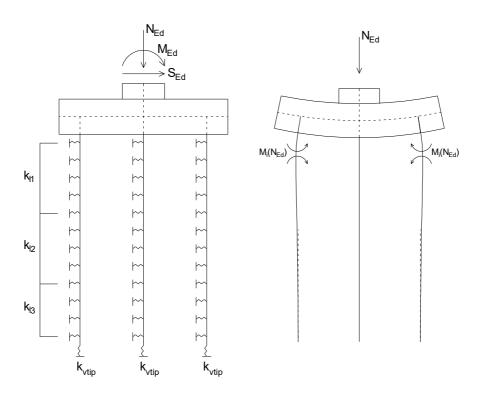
Modello del plinto su pali ed effetto flessionale su pali dovuto al carico assiale agente sul plinto (a destra)
